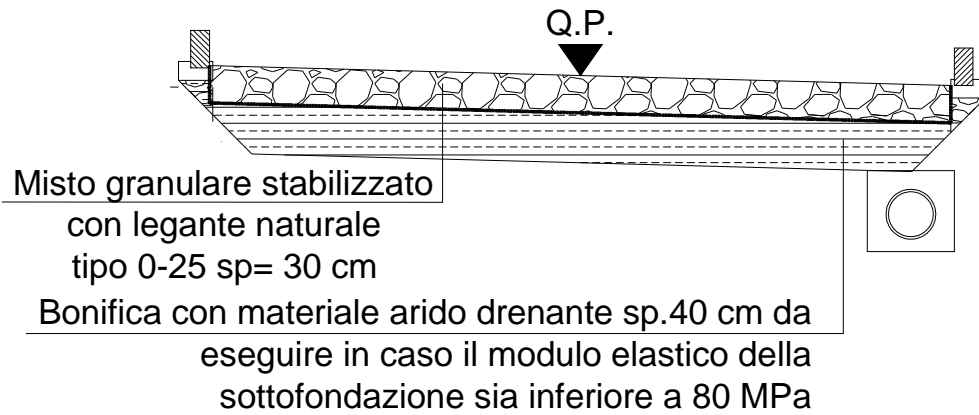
Pavimentazione per Strada di Cantiere Fase Esecutiva Strutture
